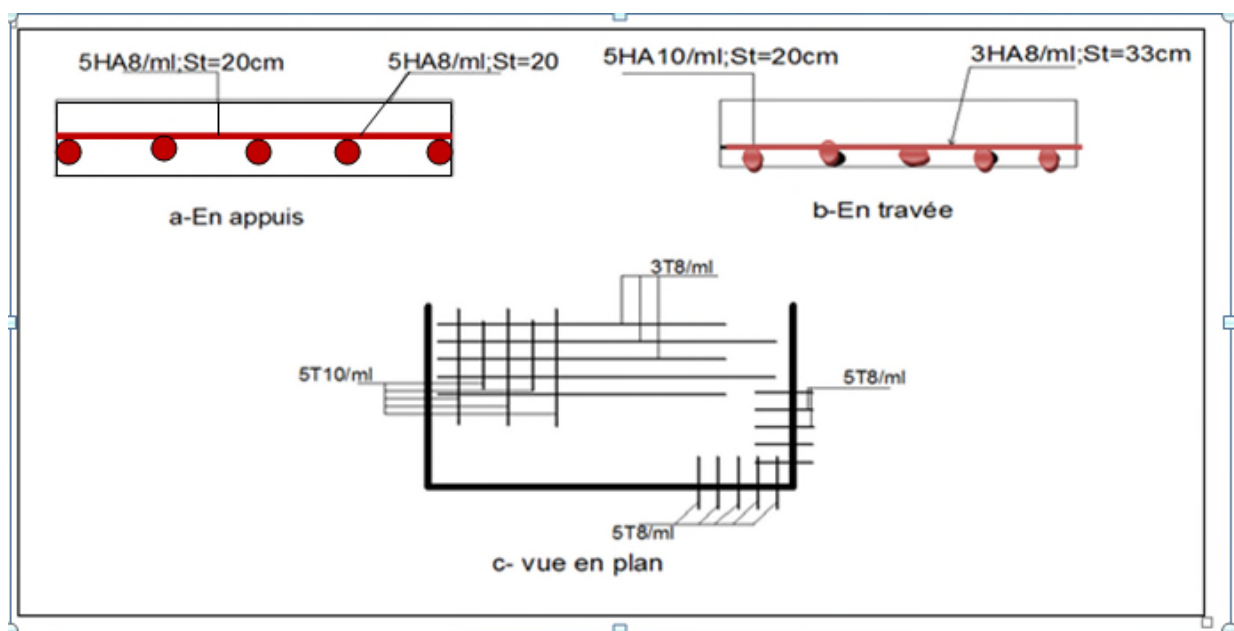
Schéma de ferrailage de la dalle sur trois appuis
